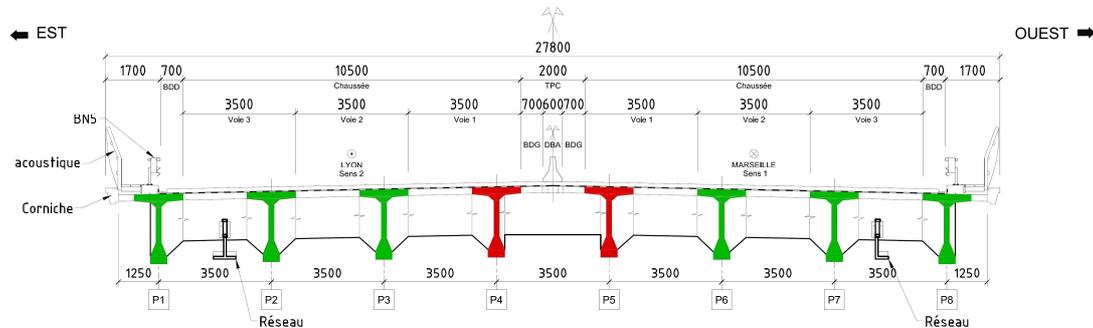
coupe transversale de l'ouvrage – les poutres 4 et 5 comportent un câble relevé supplémentaire
